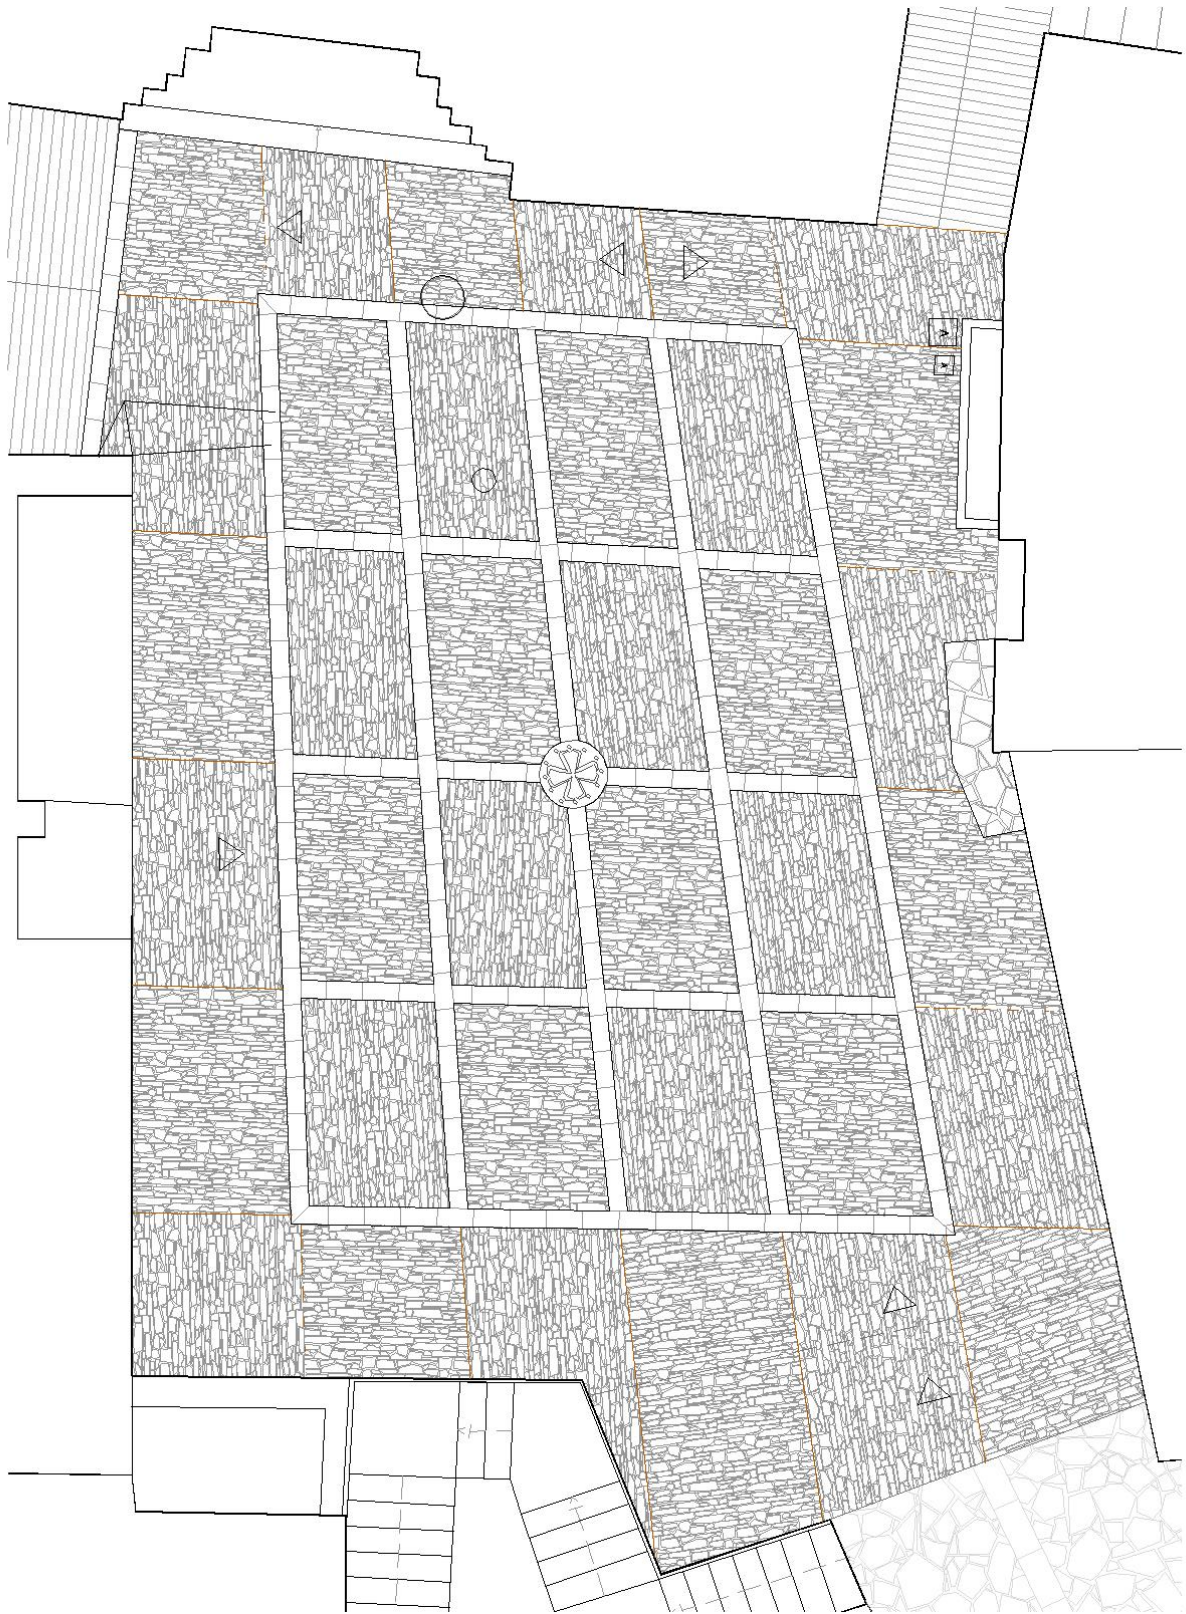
Planta Plaça de l'Església amb la posició longitudinal o transversal de la pedra col·locada en llibret.
